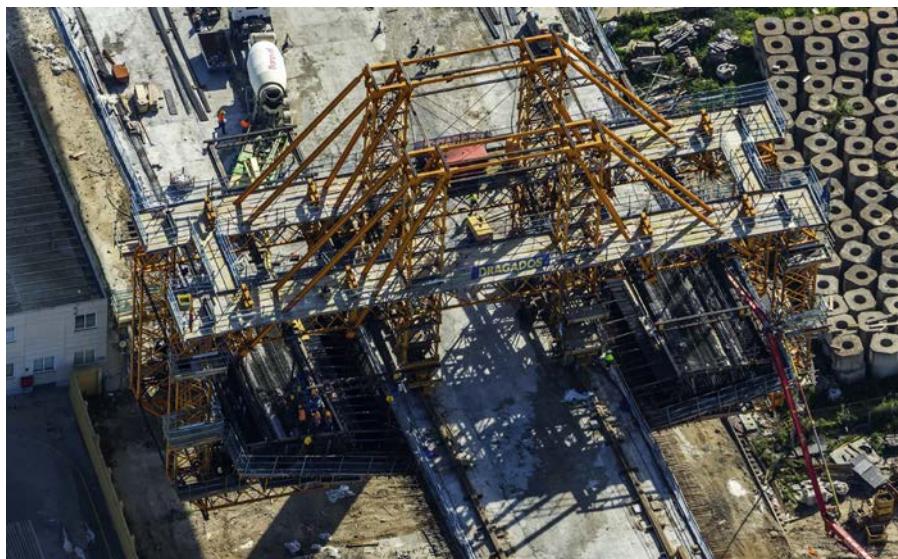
Tablero de hormigón. Carro de encofrado de segunda fase.
